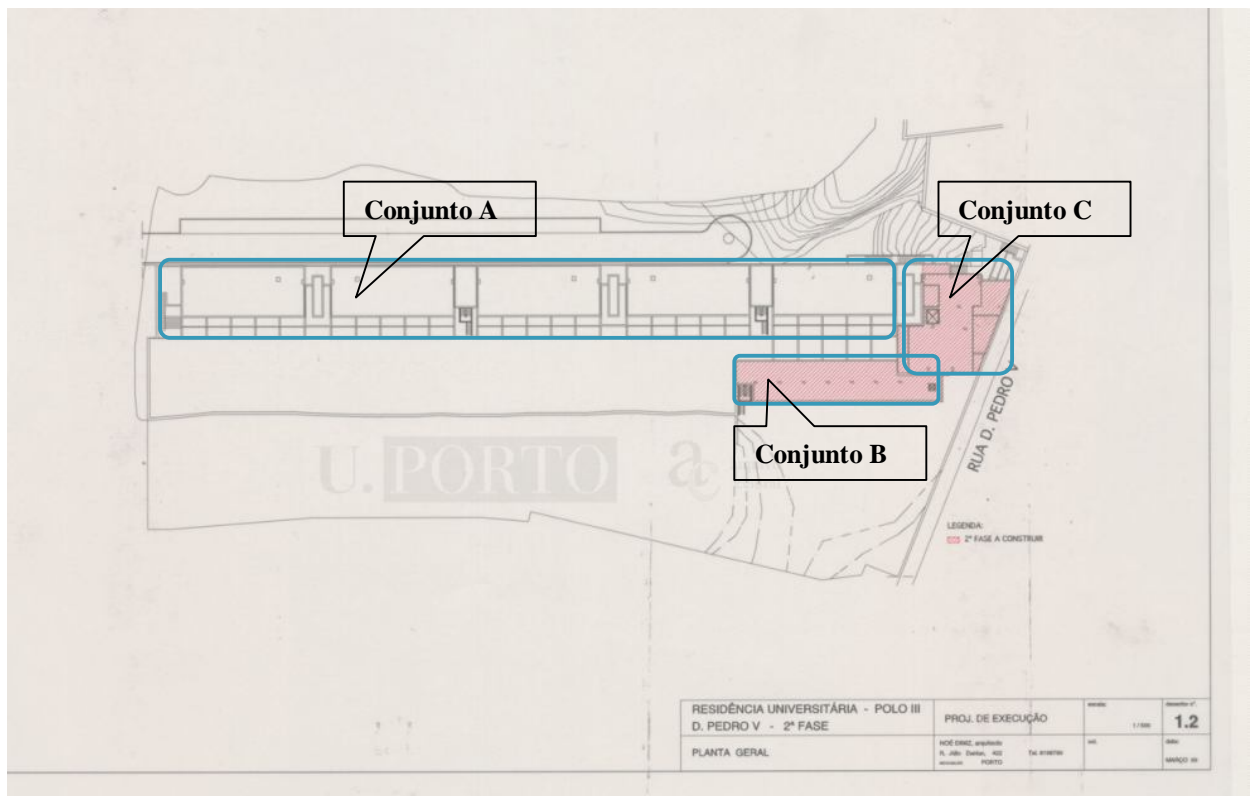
Planta da RUCA II (2ª fase de construção a cor-de-rosa).
